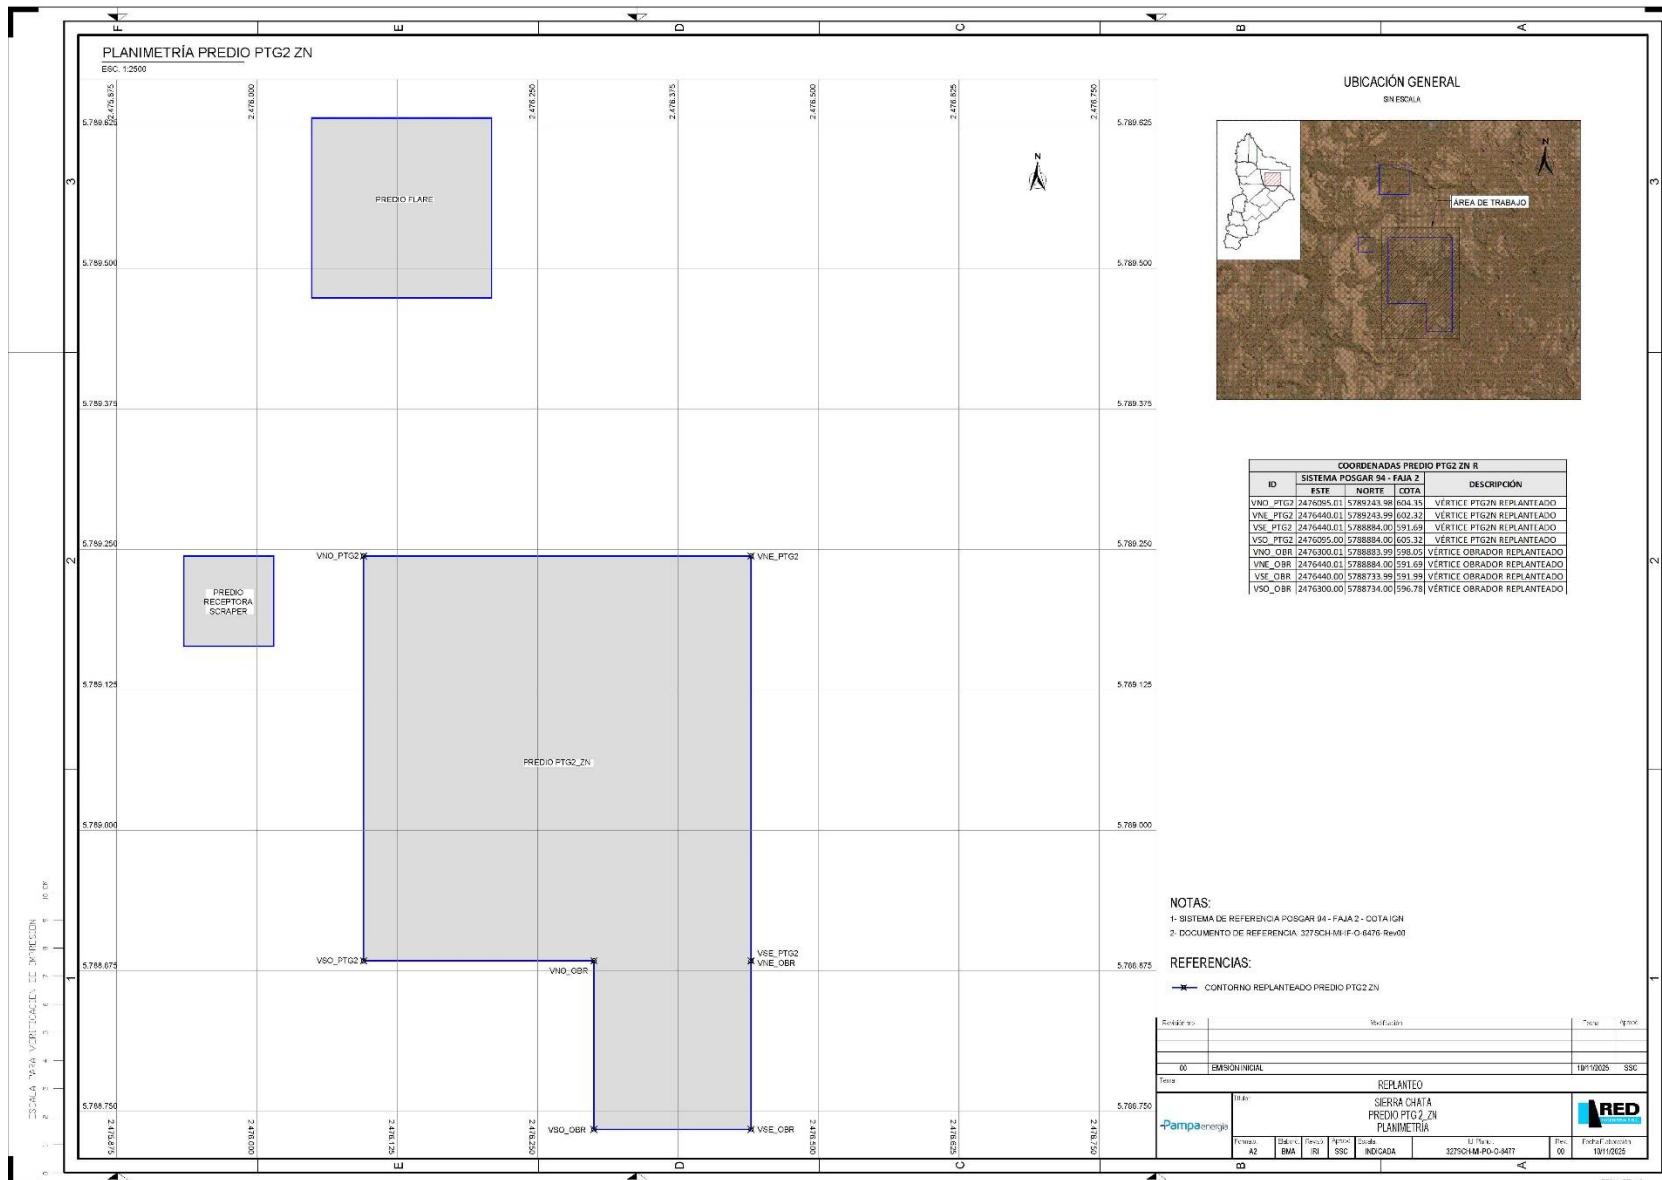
Planimetría de la futura PTG 2 Norte.
